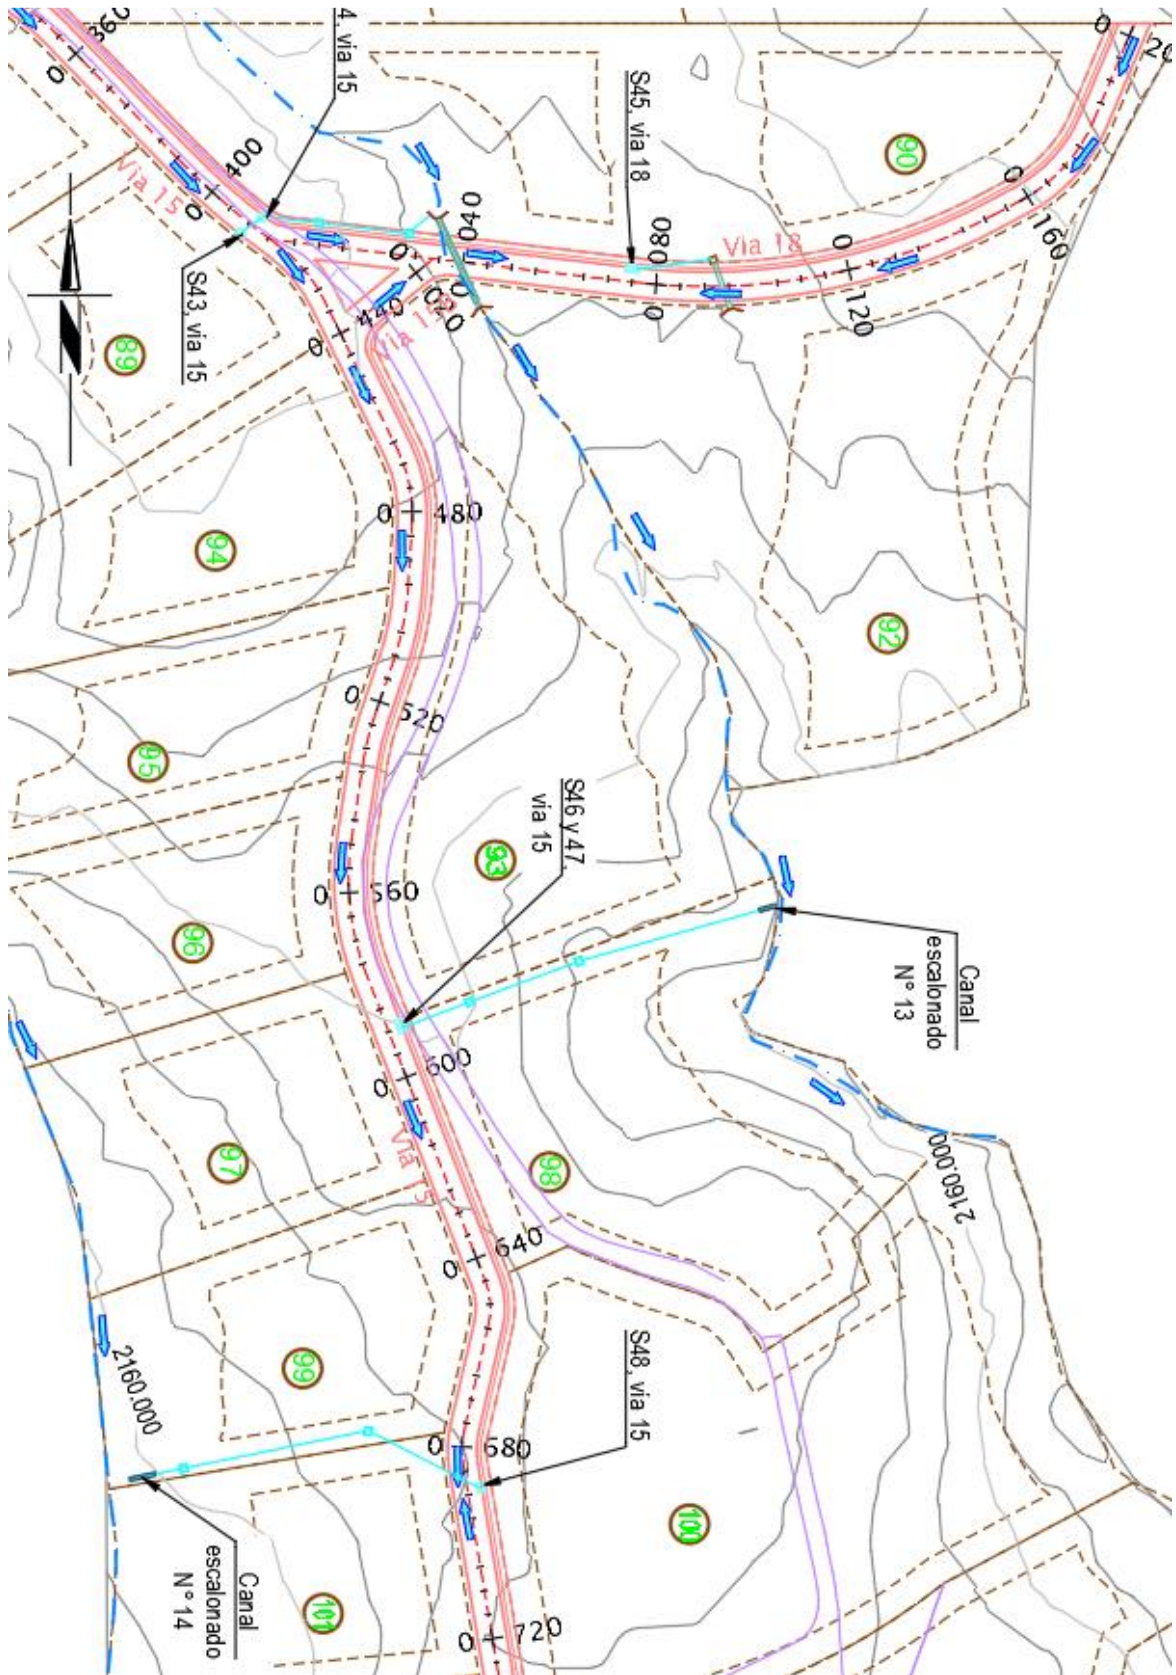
Planta de la red de lluvias para Essenza parte 1
